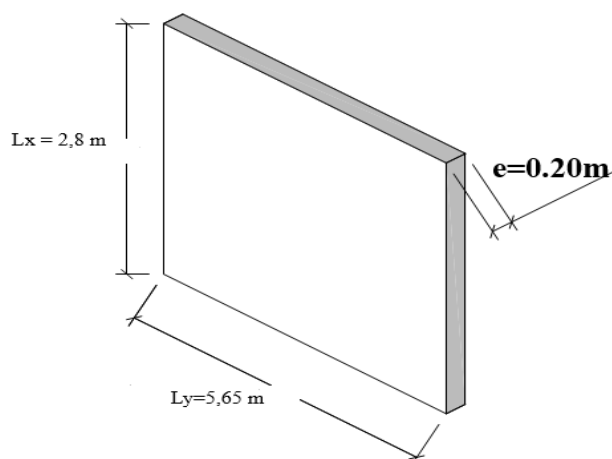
Vue illustrant les dimensions du panneau le plus sollicité.
